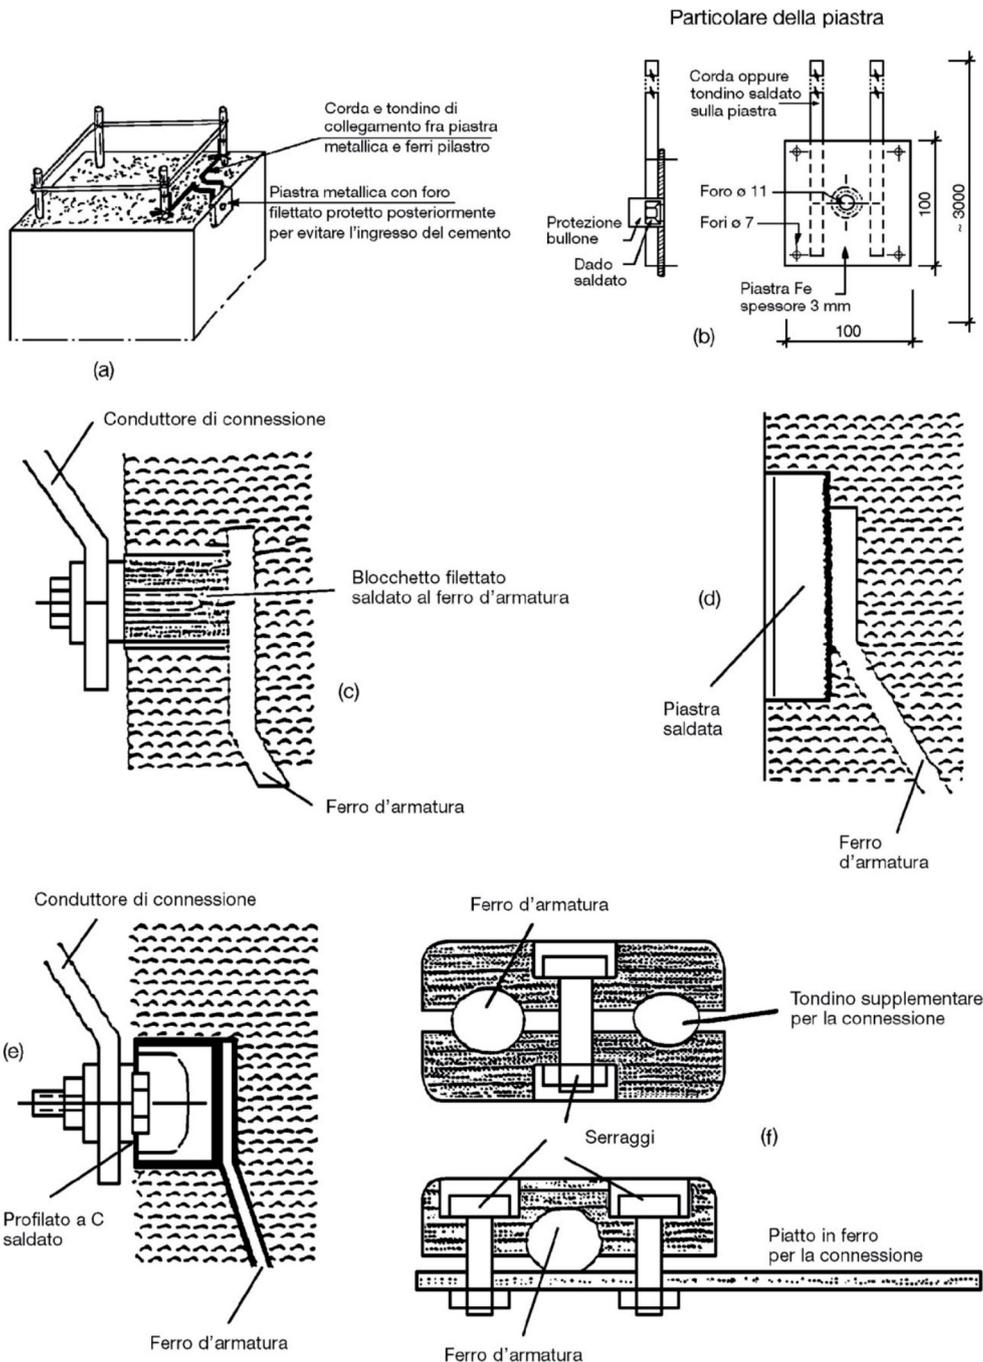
Esempi di collegamento ai ferri del pilastro o del plinto con piastra metallica (o con altri elementi metallici) incorporata nel getto del calcestruzzo, particolarmente adatti per elementi prefabbricati.
